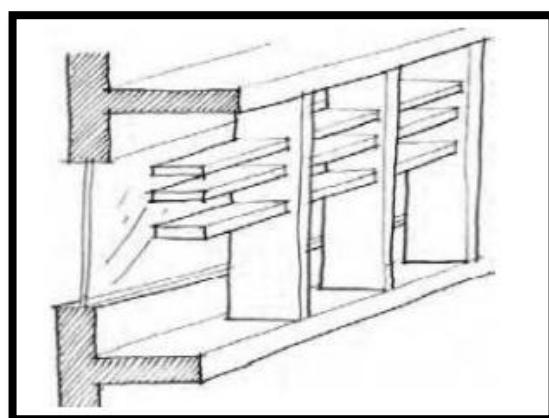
أنواع الكاسرات الأفقية .(Mechanical and Electrical Equipment for Buildings)
